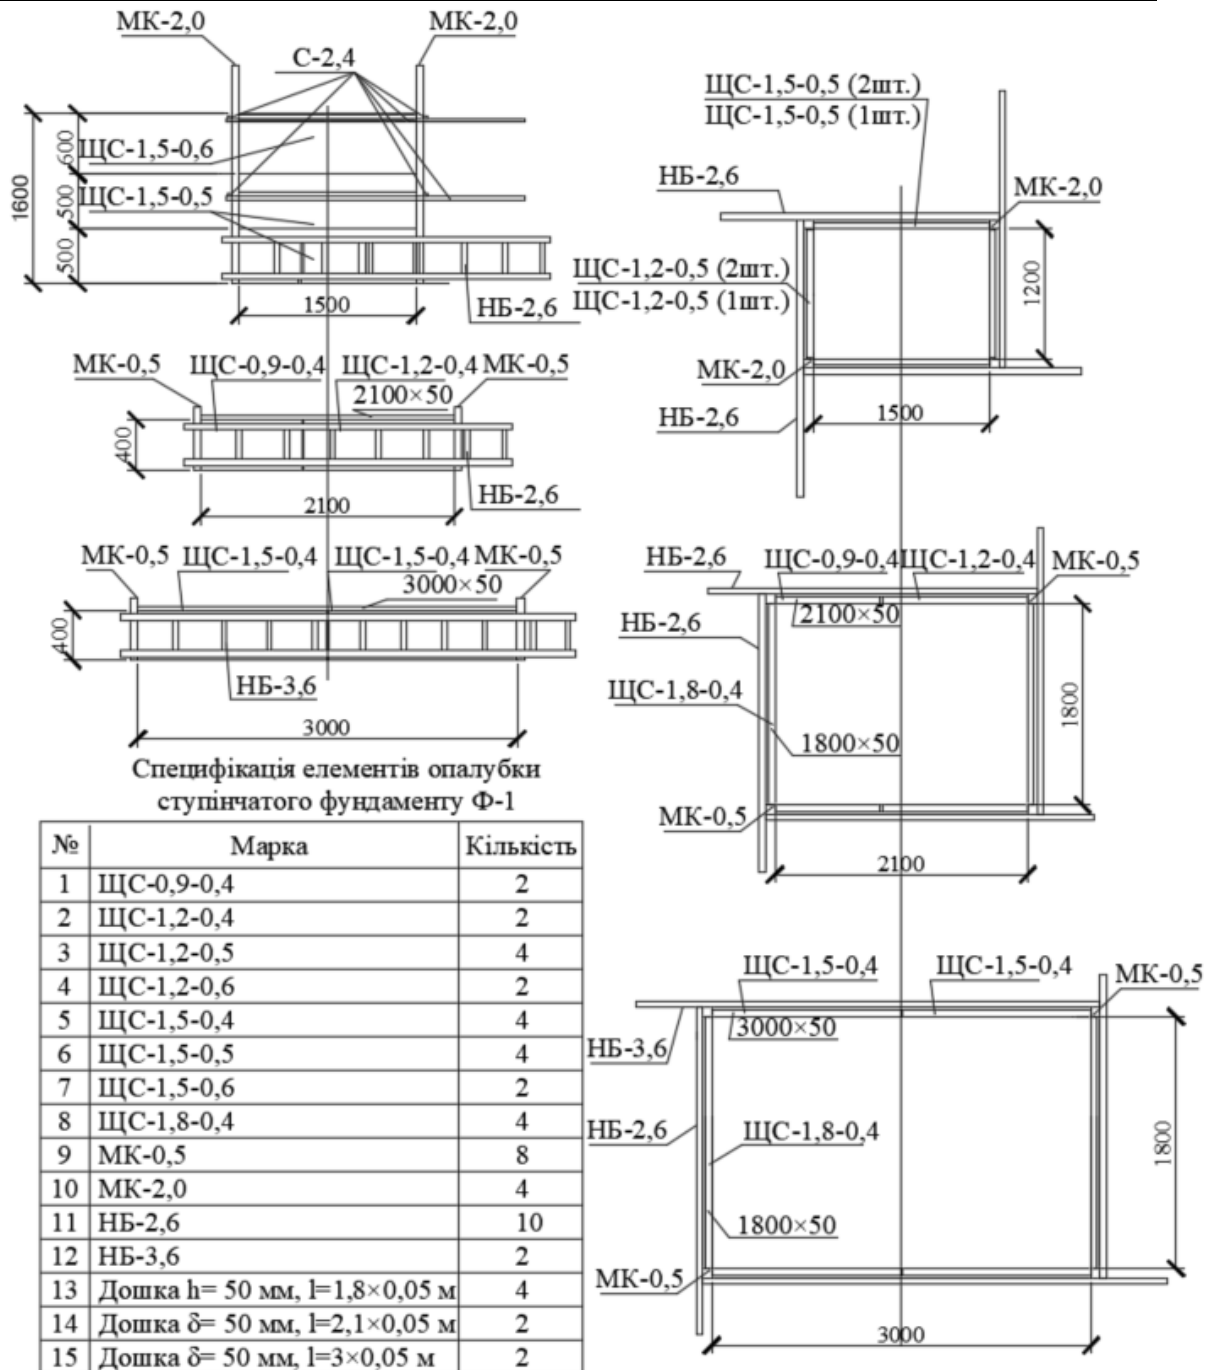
Маркувальна схема ступінчастого фундаменту зі специфікацією елементів опалубки
